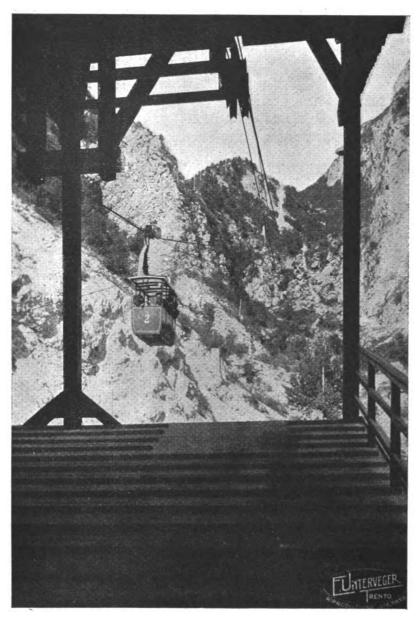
Funivia Zambana-Fai: La stazione inferiore.
